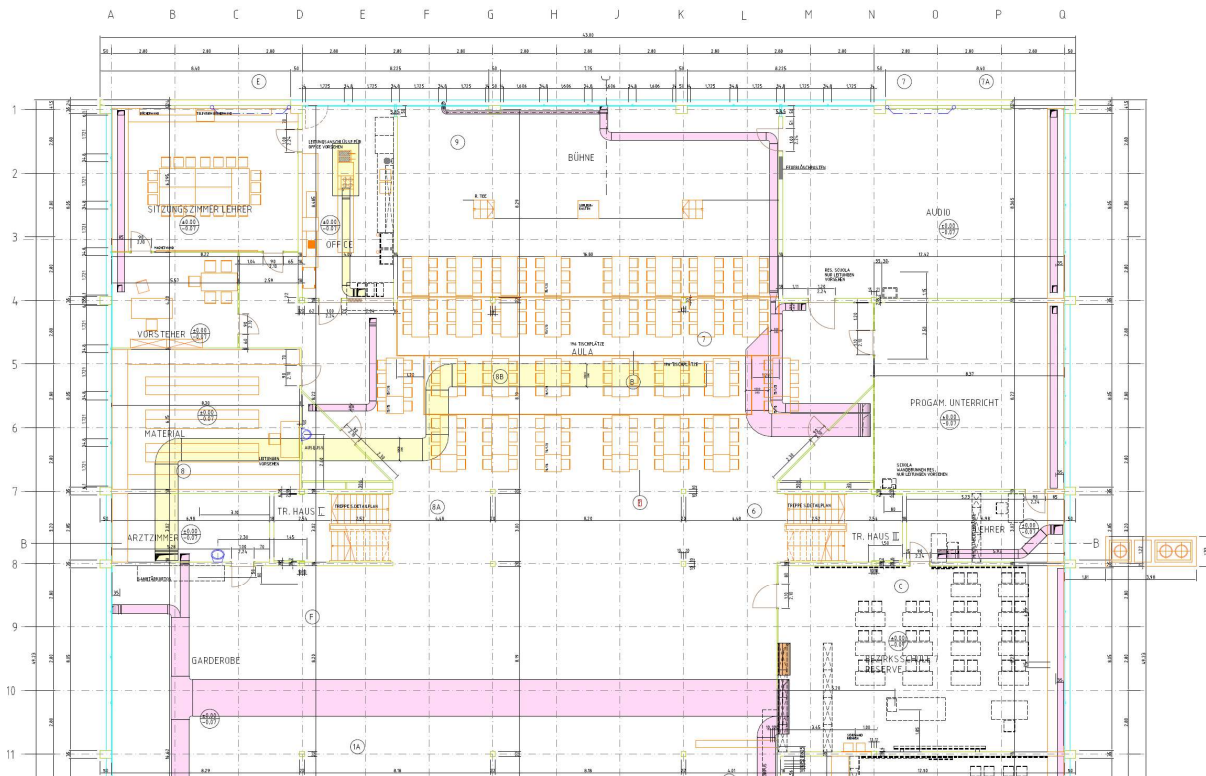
, Plan bestehende Lüftungsanlage Raimann + Partner AG
